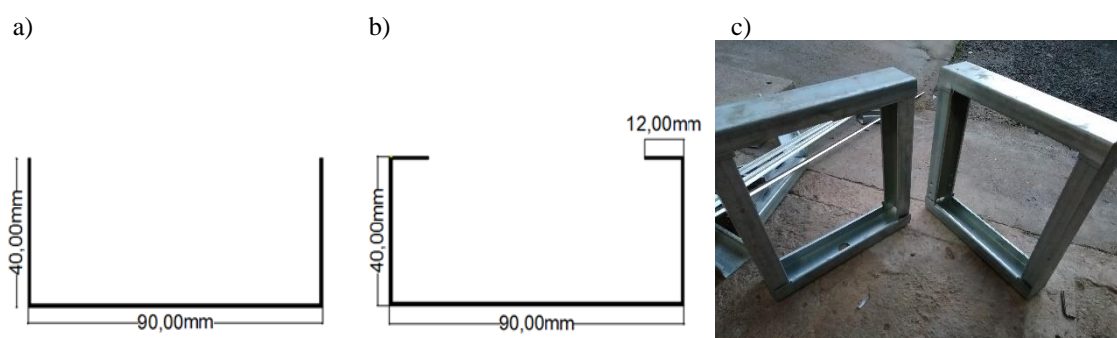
Perfis leves de aço zincado. a) Dimensões Perfil U. b) Dimensões Perfil Ue, também conhecido como U enrijecido. c) Estrutura metálica dos painéis executada.
